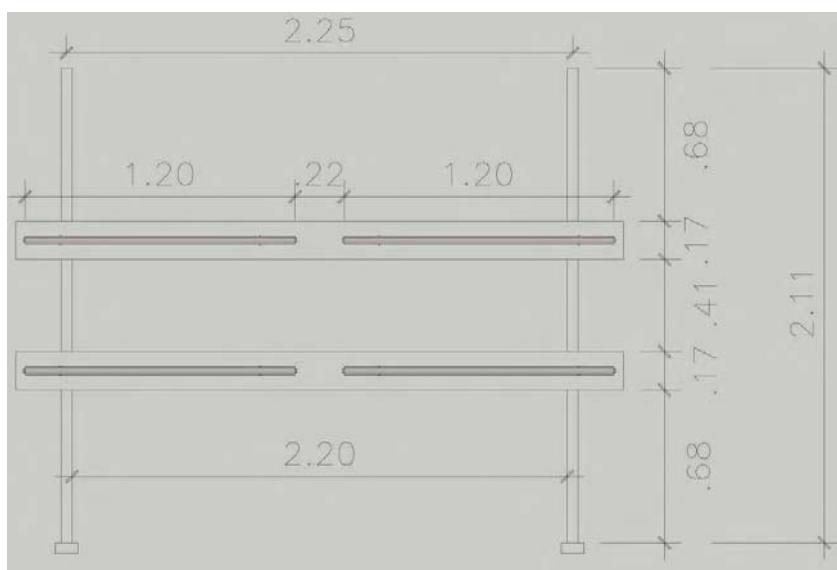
Vista posterior da estrutura em madeira para suporte da iluminação (dimensão em metros)
